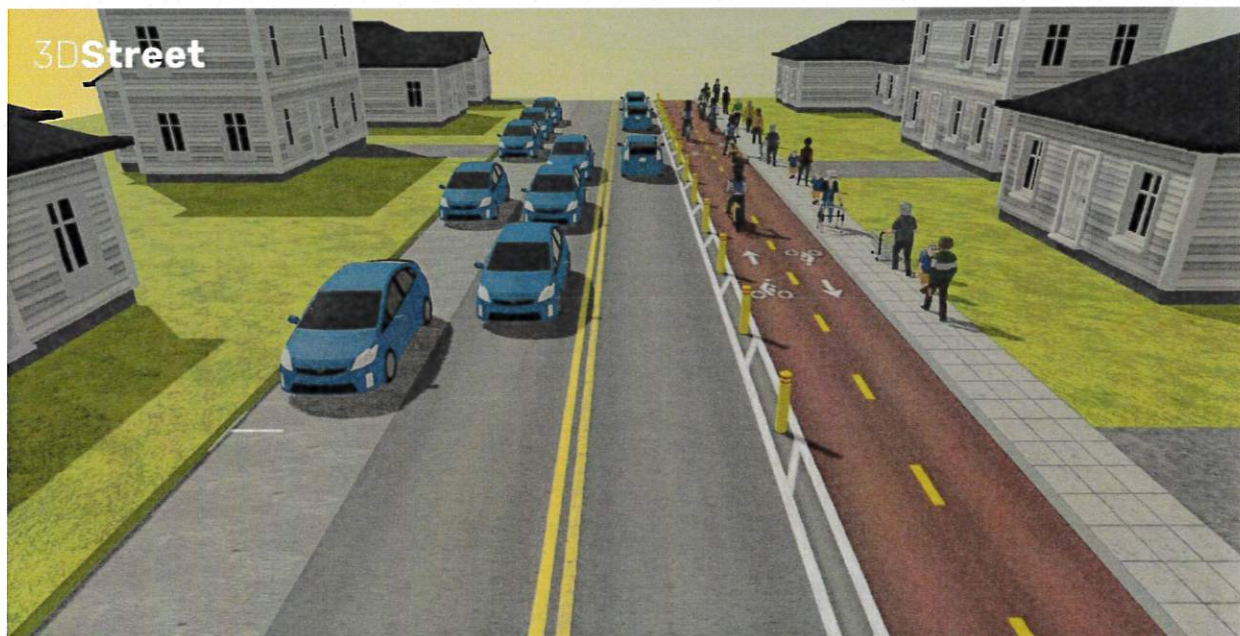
Vedere 3D profil transversal str. Andrei Mureșanu - situația propusă
